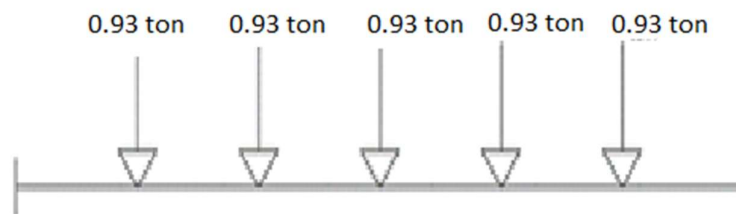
Diagrama de fuerzas de viga de cubierta VCU
